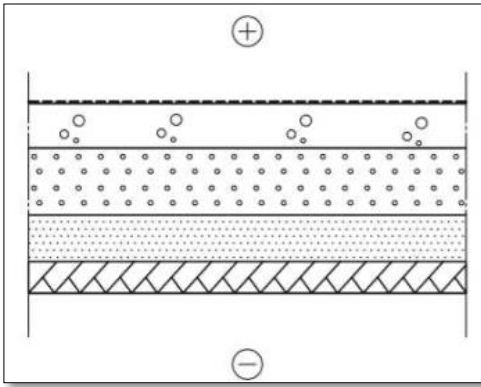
Rakenneavauksesta RA13 todennettu alapohjarakenne sisältä ulospäin: muovimatto, 80 mm:n pintabetonilaatta, 140 mm:n kevytbetoni ja pohjabetonilaatta.
